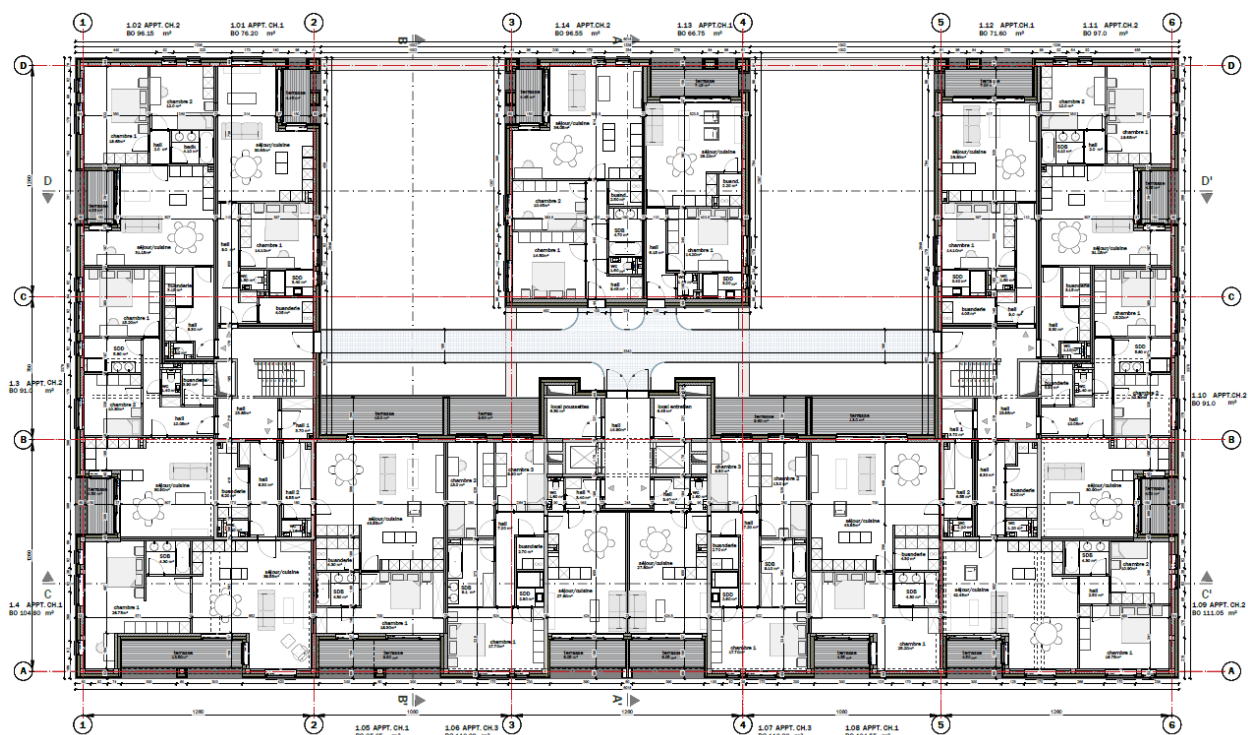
Extrait de plan du R+1 (source : ARTER Architects)
